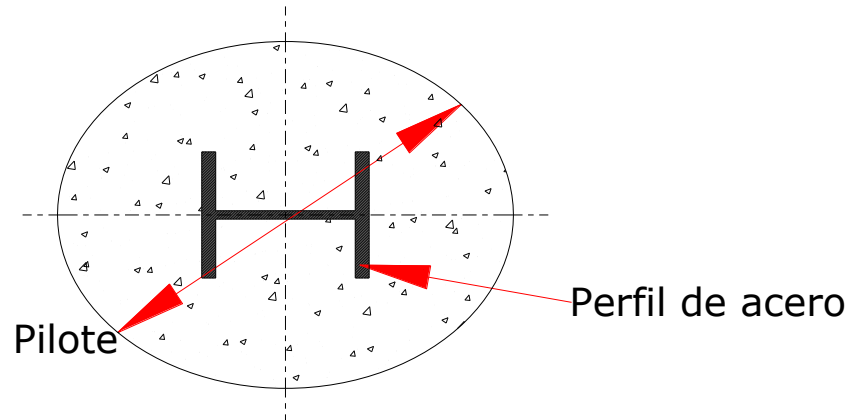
Sección transversal de un pilote con un perfil de acero embebido
